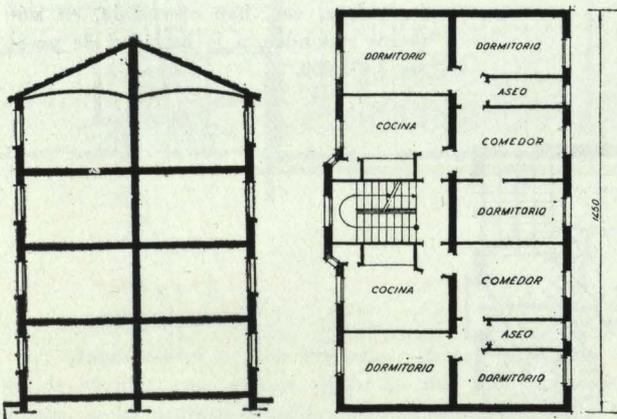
Sección tipo de una vivienda del Grupo de Los Almendrales, Usera (Madrid).
